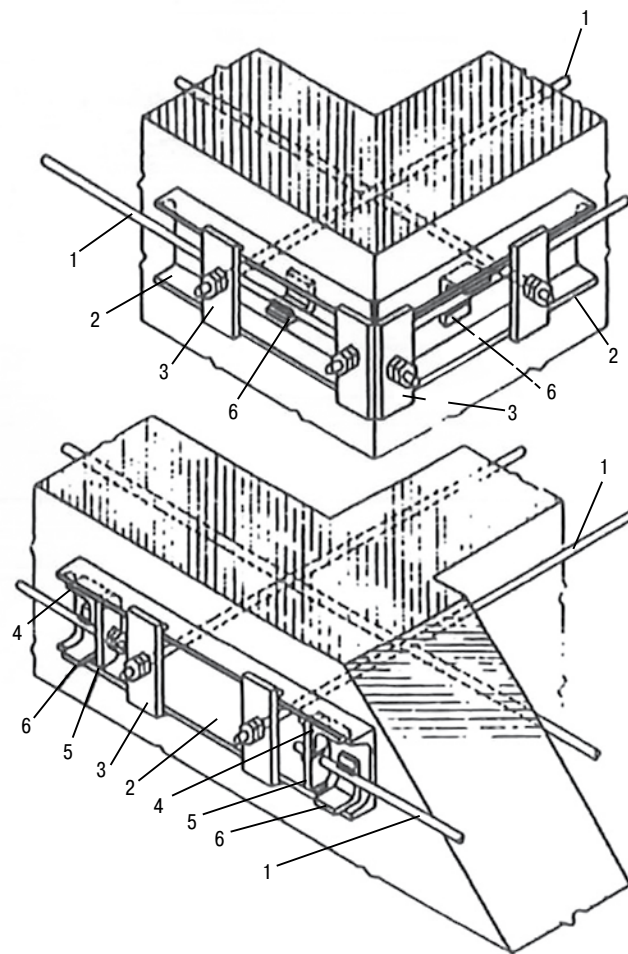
Схема усиления стен здания с помощью парных стальных тяжей: а) на углу здания; б) на пересечении наружной стены с внутренней; 1 – тязь, 2 – обжимной элемент, 3 – опорная накладка, 4 – опорный угольник, 5 – опорная косынка, 6 – угольник для защиты тязя от скручивания, 7 – накладка для увеличения жесткости обжимного элемента
